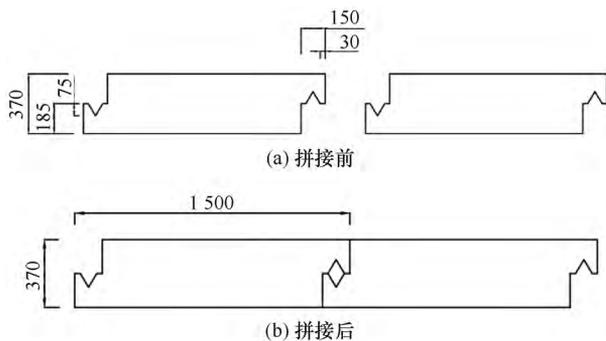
钢筋混凝土组合坝墙拼接前后俯视(单位: mm)
